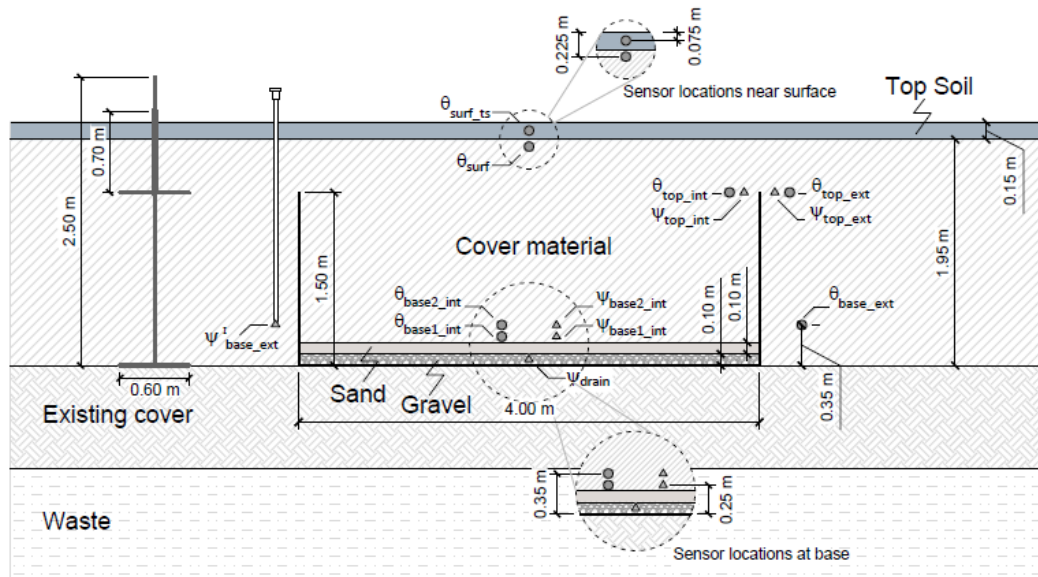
Coupe de profil avec les instrumentations du L2
